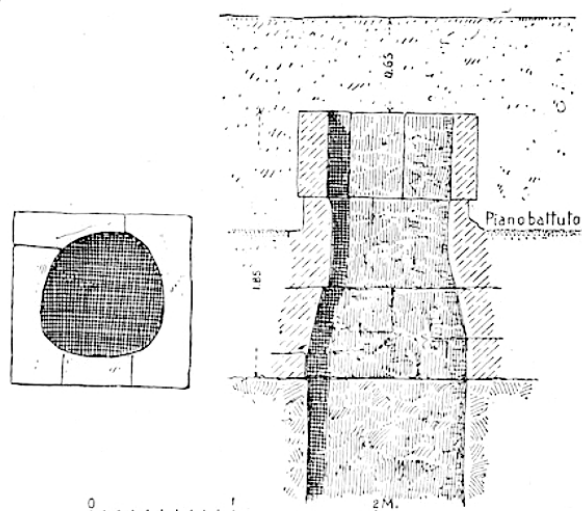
Ortigia, Piazza Minerva: sezione e pianta del pozzo antico rilevate da R. Carta (ORSI 1918, fig. 3.)
